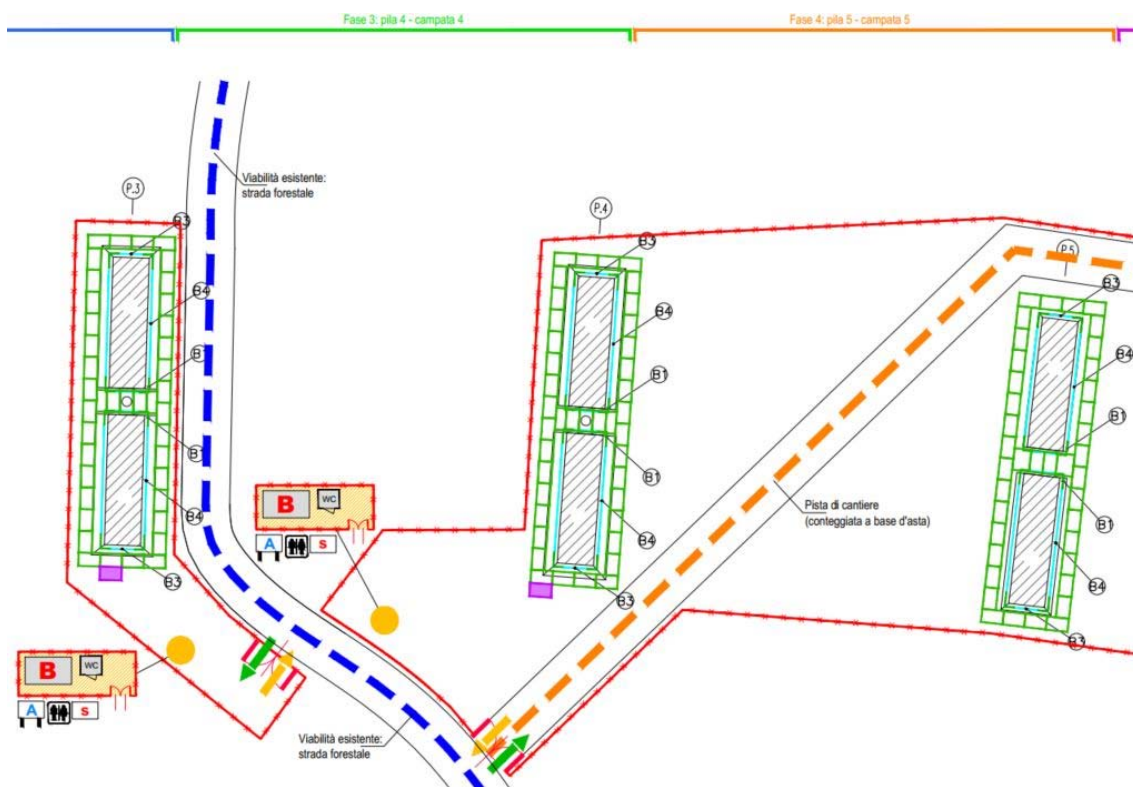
planimetria area di cantiere, fase 2, 3 e 4
